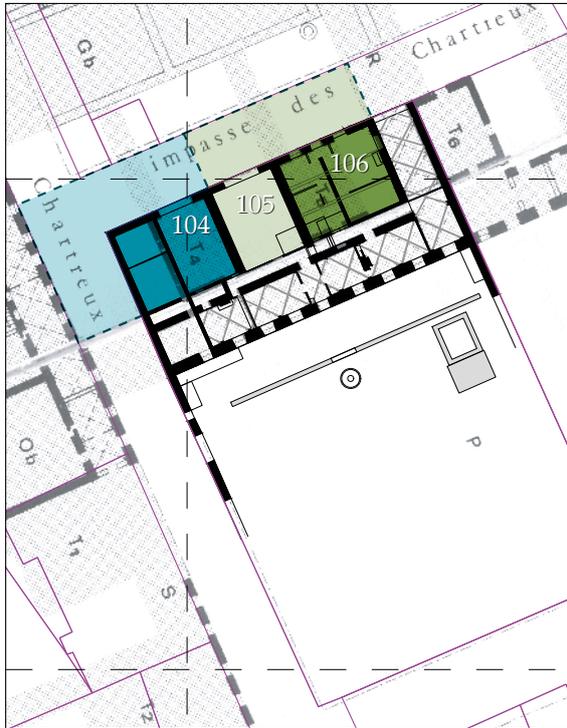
Restitution des nouvelles dispositions des cellules 104 et 105 sur le fond de plan du Service de l'Inventaire général, 1987 (DAO M. Panneau)
